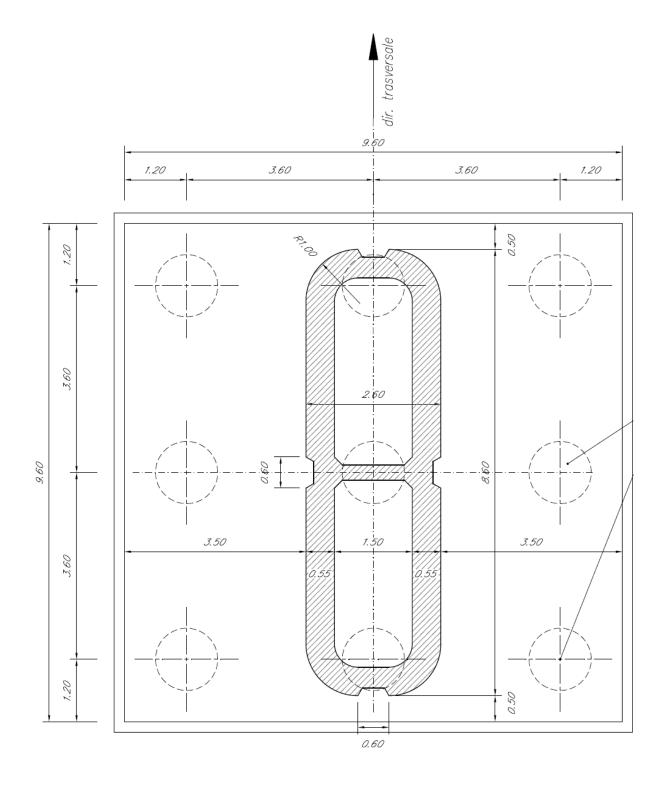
Plinto di fondazione e pali, vista in pianta - Sezione del fusto pila [m]
